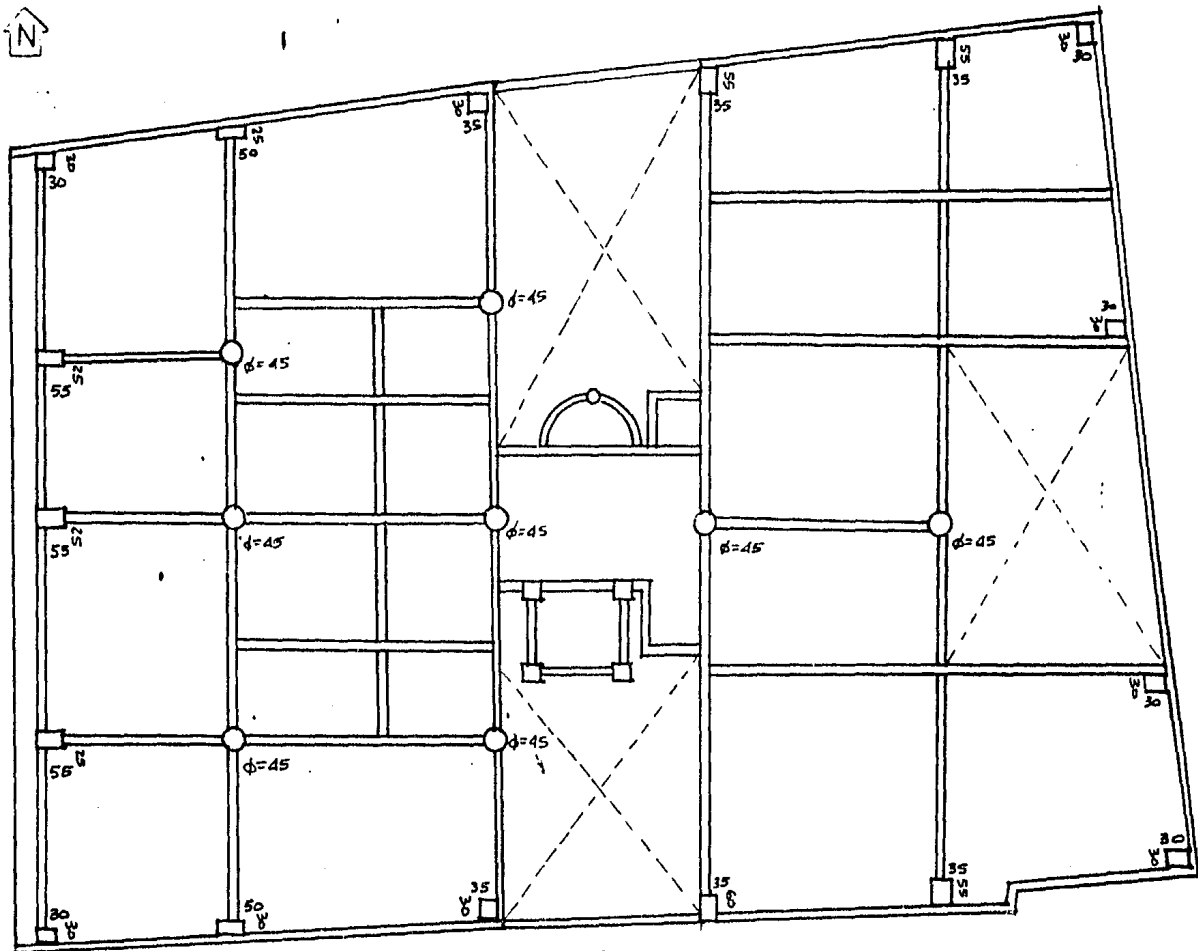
d Dimensión de columnas (cm) Nivel 6 y 7
